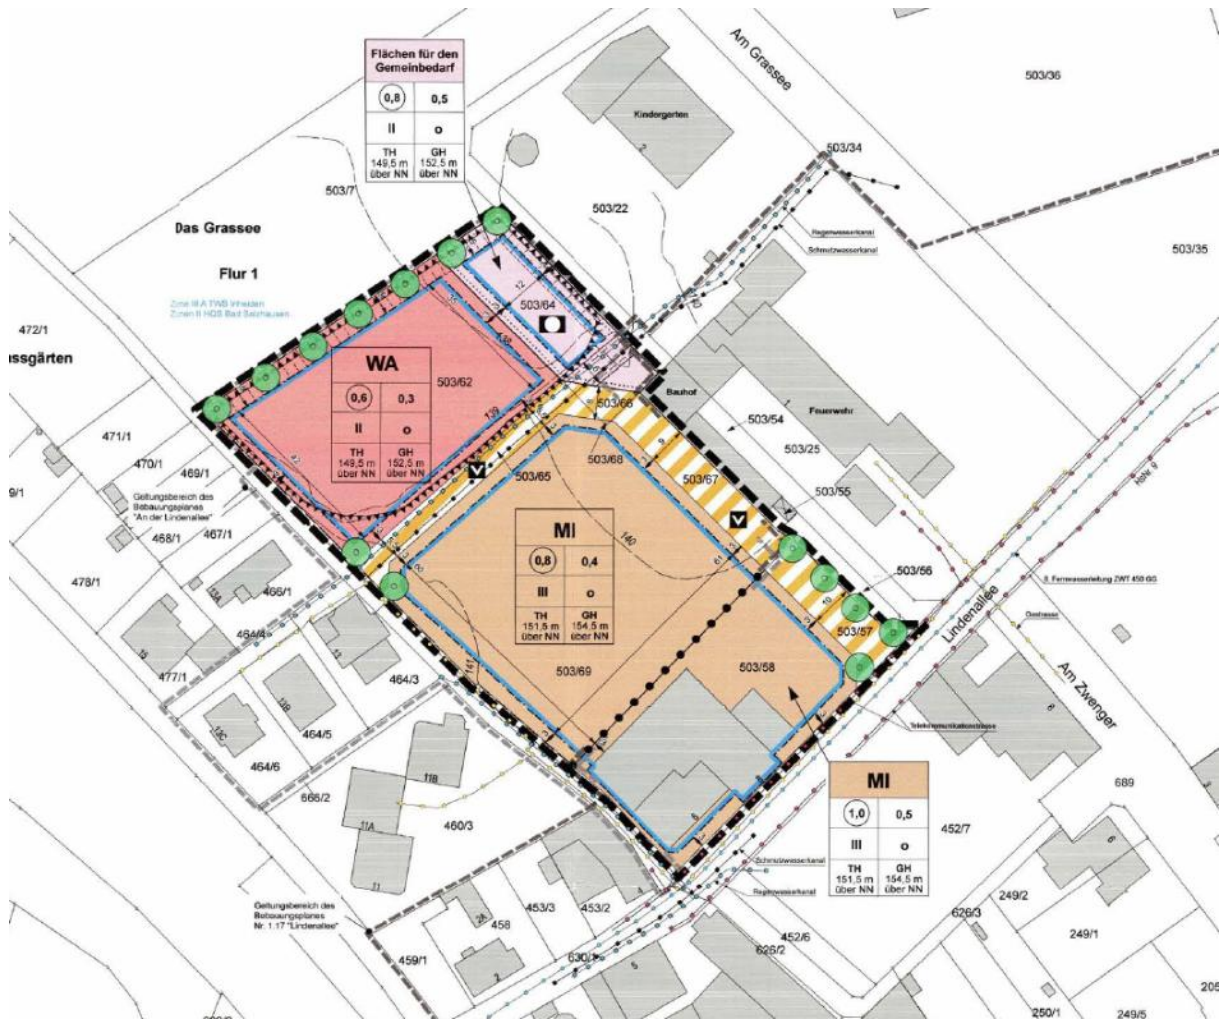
1. Änderung des Bebauungsplans „An der Lindenallee“
